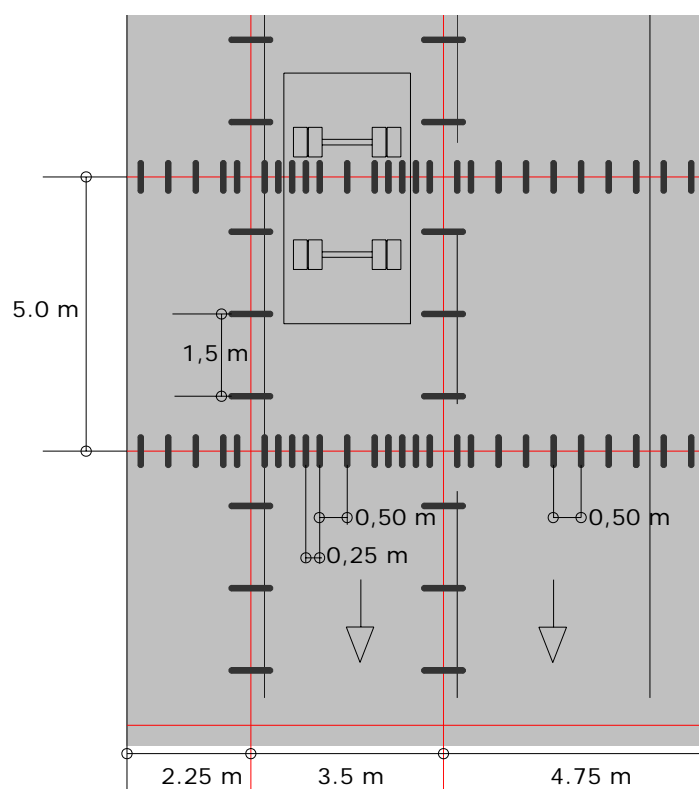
Planta de distribución de pasadores, barras de atado y juntas
